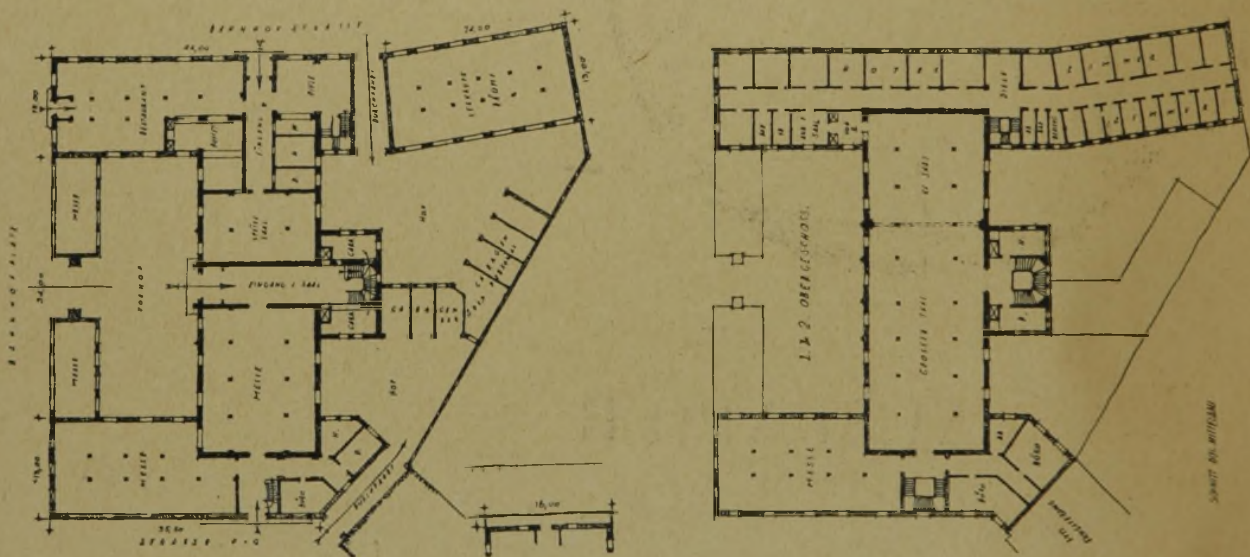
u. 11. Grundrisse zu Abb. 13. II. Preis. Maßstab rd. 1 : 975. Grundrisse um 90° gedreht.
